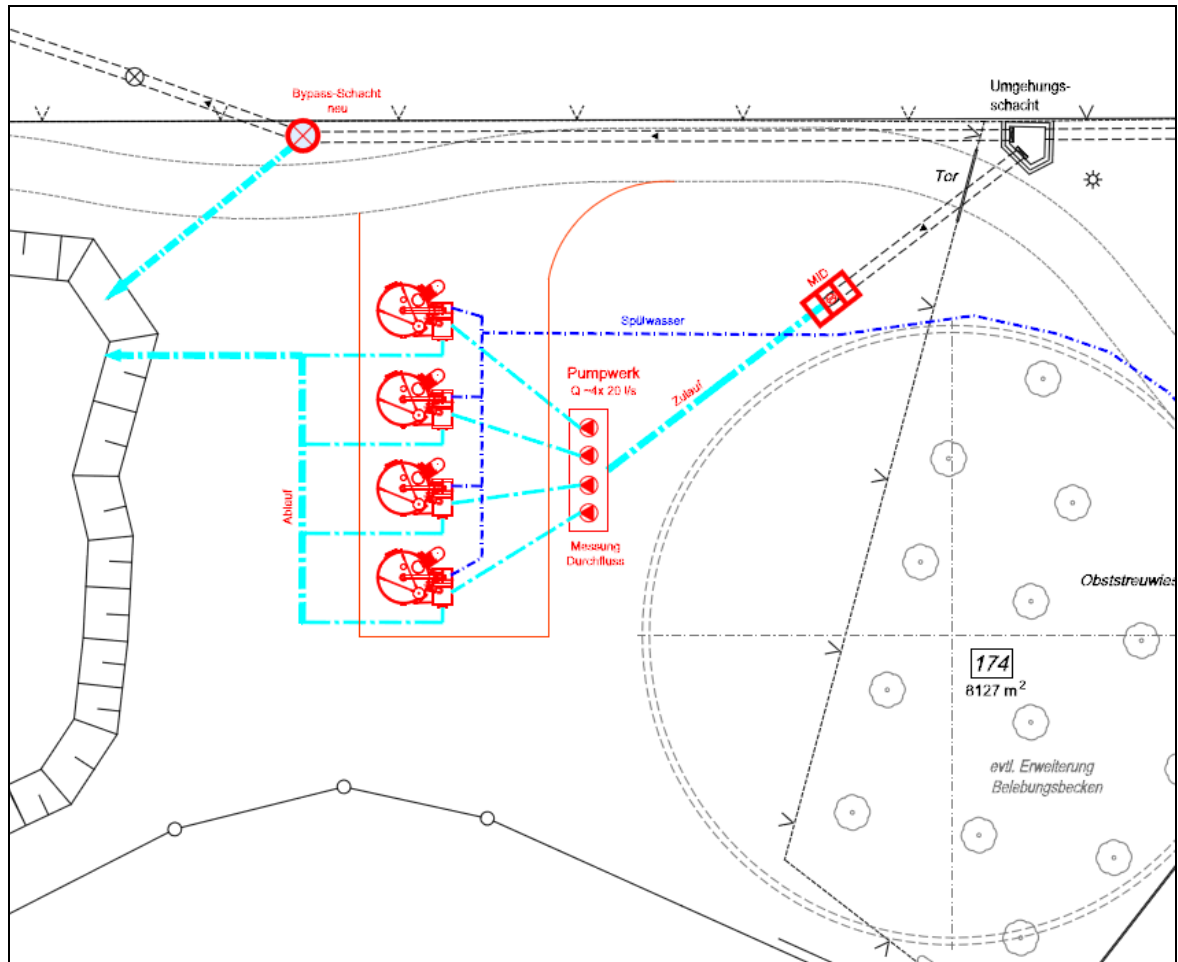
Lageplan KA Verl West - Variante 2.3 – GAK in automatischem Schwerkrafftfilter
